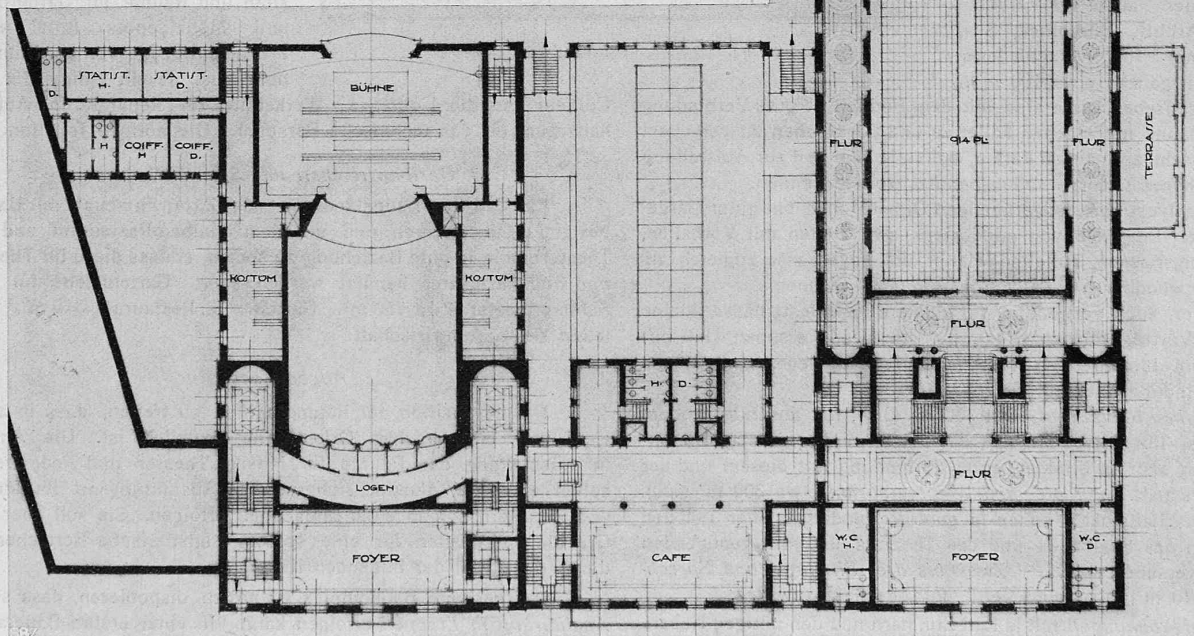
Theater- und Saalbau für Winterthur. Grundriss vom I. Stock. — Masstab 1 : 600.
